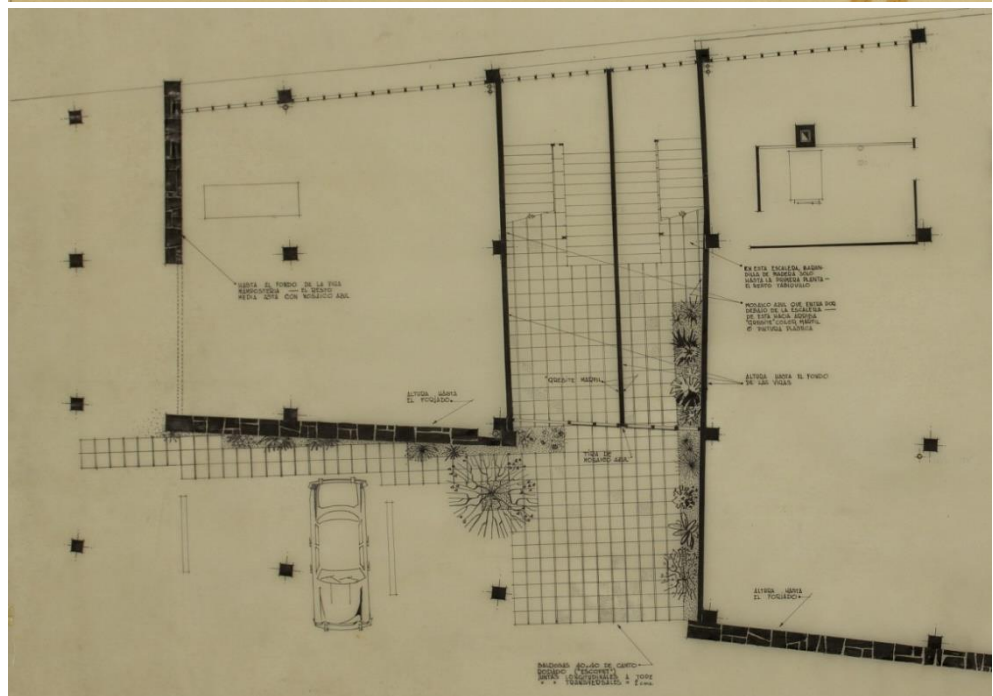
Planta del piso bajo del edificio de oficinas y viviendas.
